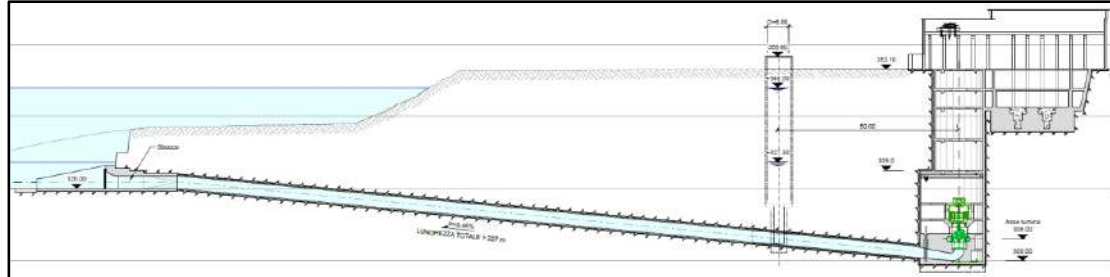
Centrale di Cucchinadorza: stato di progetto
